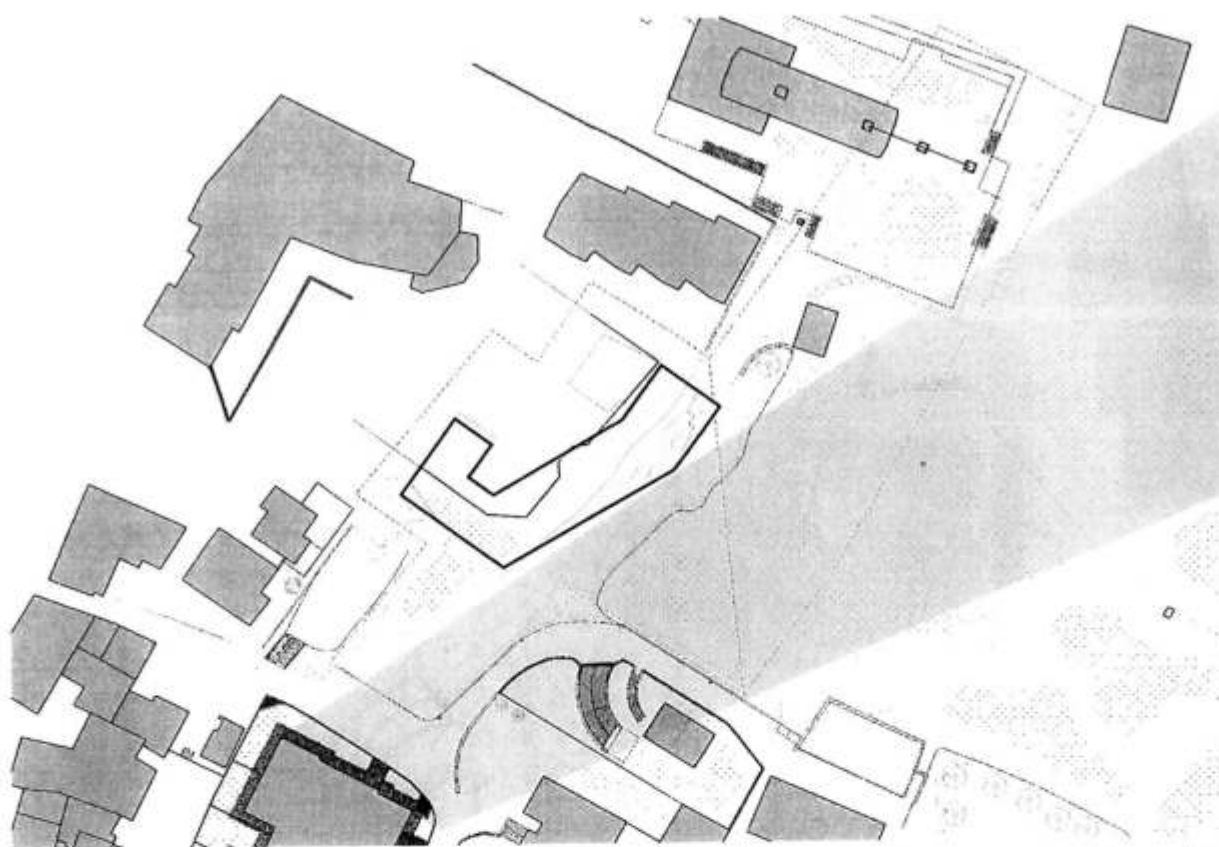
Sovrapposizione profilo PDC e profilo variante con cono visivo su pista
